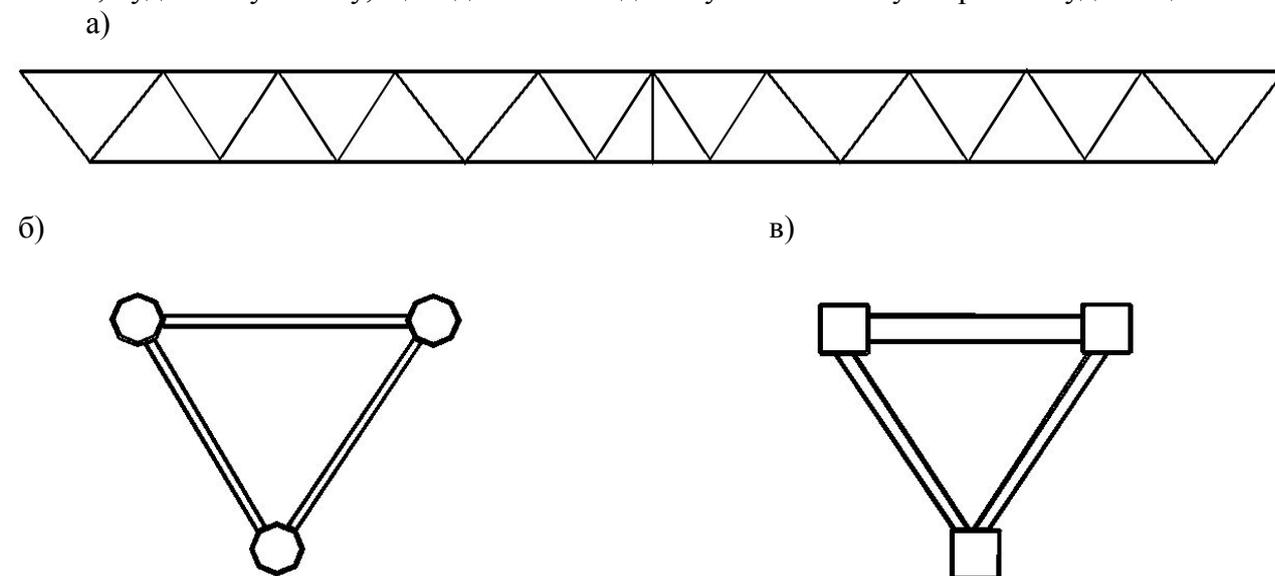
Просторова ферма із замкнених профілів–а – схема ферми із замкнених профілів; б – перерізи ферм із труб; в – перерізи ферм із прямокутних профілів
